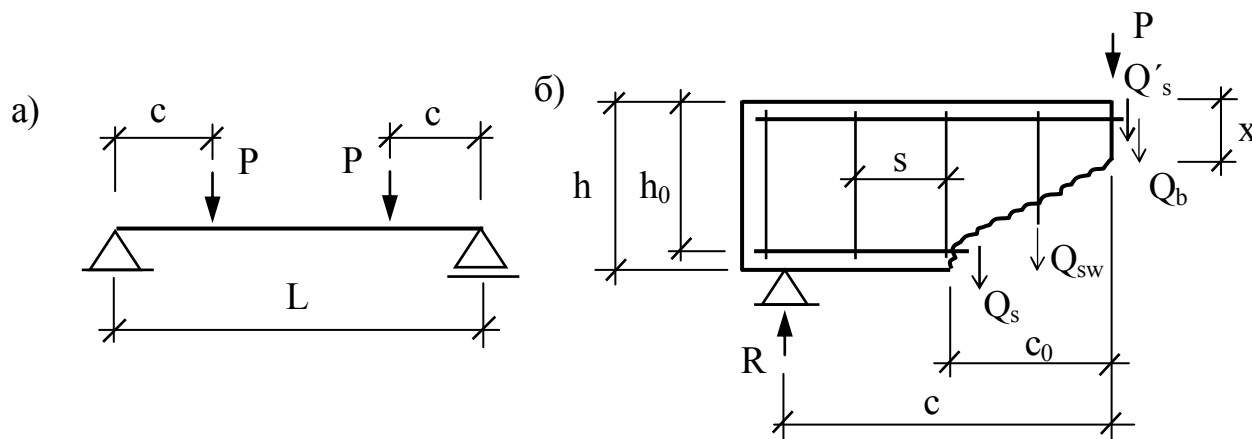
Железобетонная балка: а) расчетная схема;
